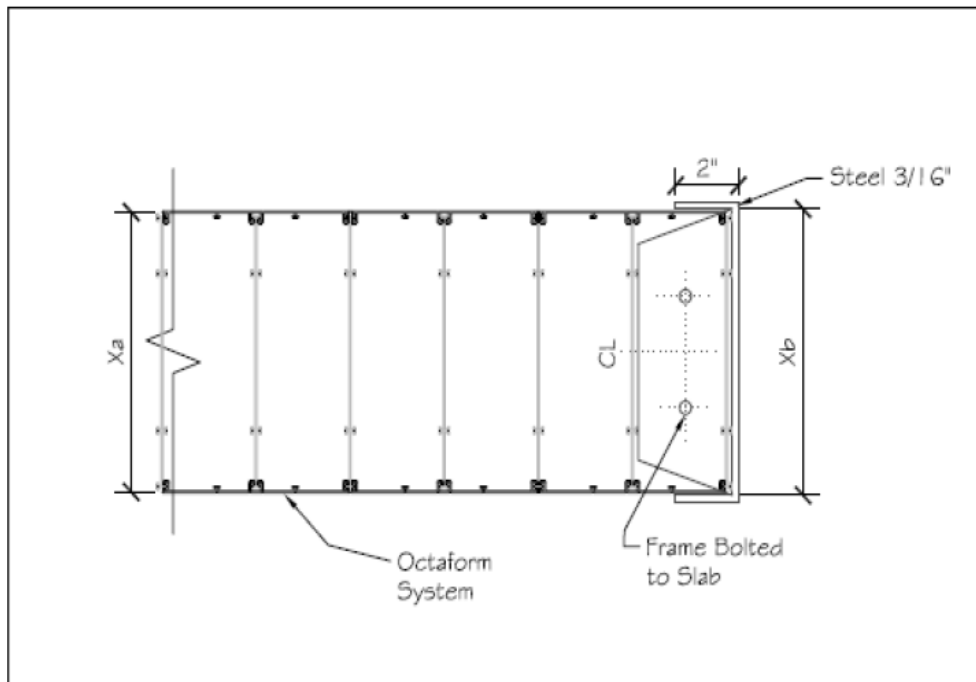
Pormenor de ligação de aro metálico à laje da fundação (corte horizontal)
